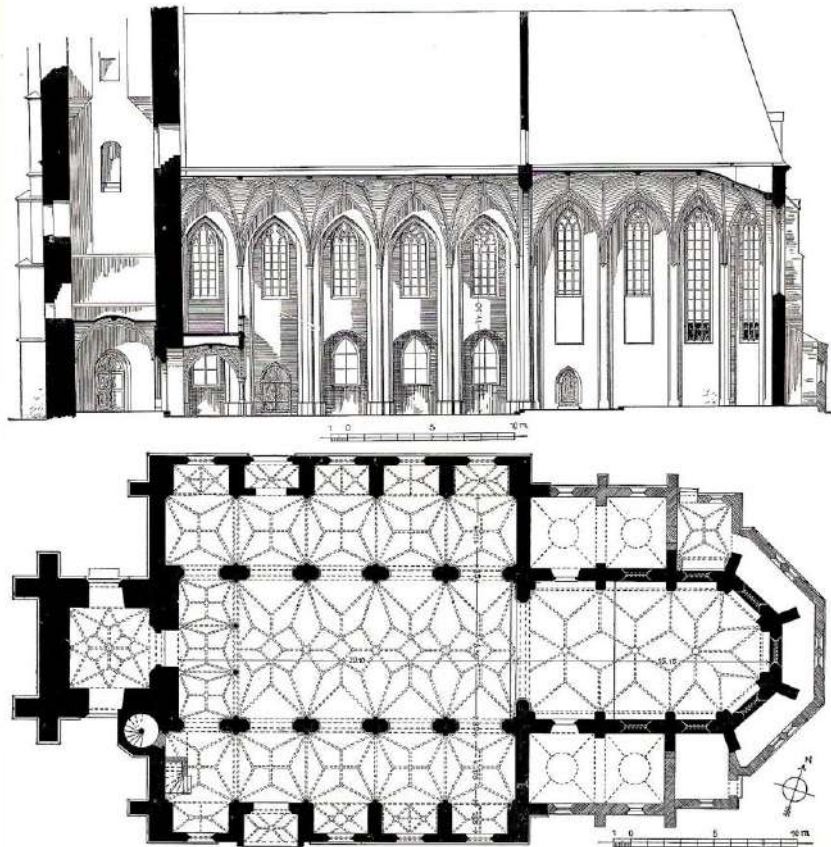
Vilsbiburg, kath. Stadtpfarrkirche Mariä Himmelfahrt, Grundriß und Längsschnitt
